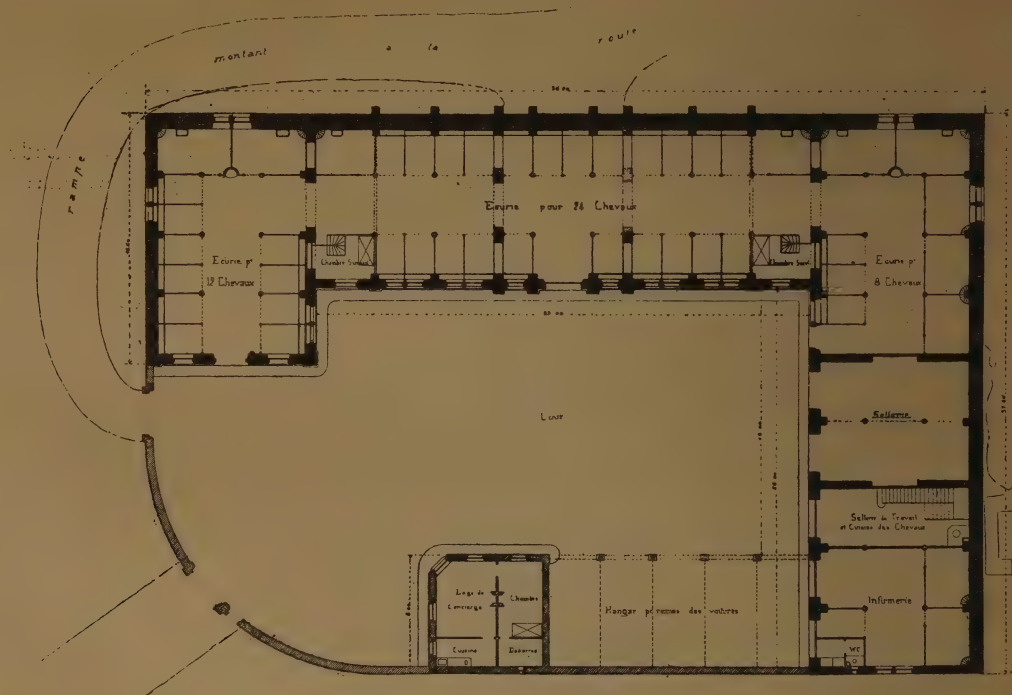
Haras à Sailhaus (Cantal), plan du rez-de-chaussée.
